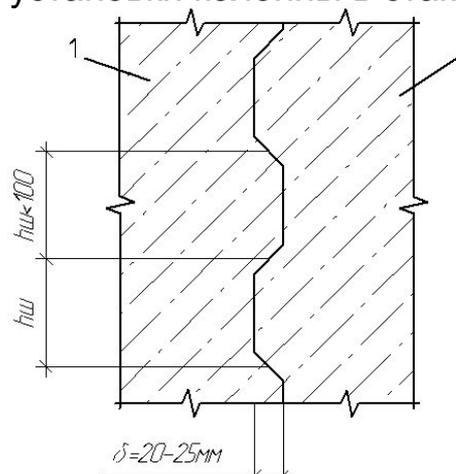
Деталь сопряжения сборной колонны с бетоном замоноличивания стакана фундамента 1 - сборная колонна; 2 - бетон замоноличивания
